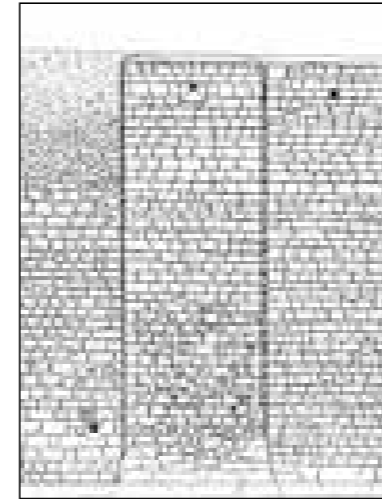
Alzado del torreón T1. (MJB 2000)
